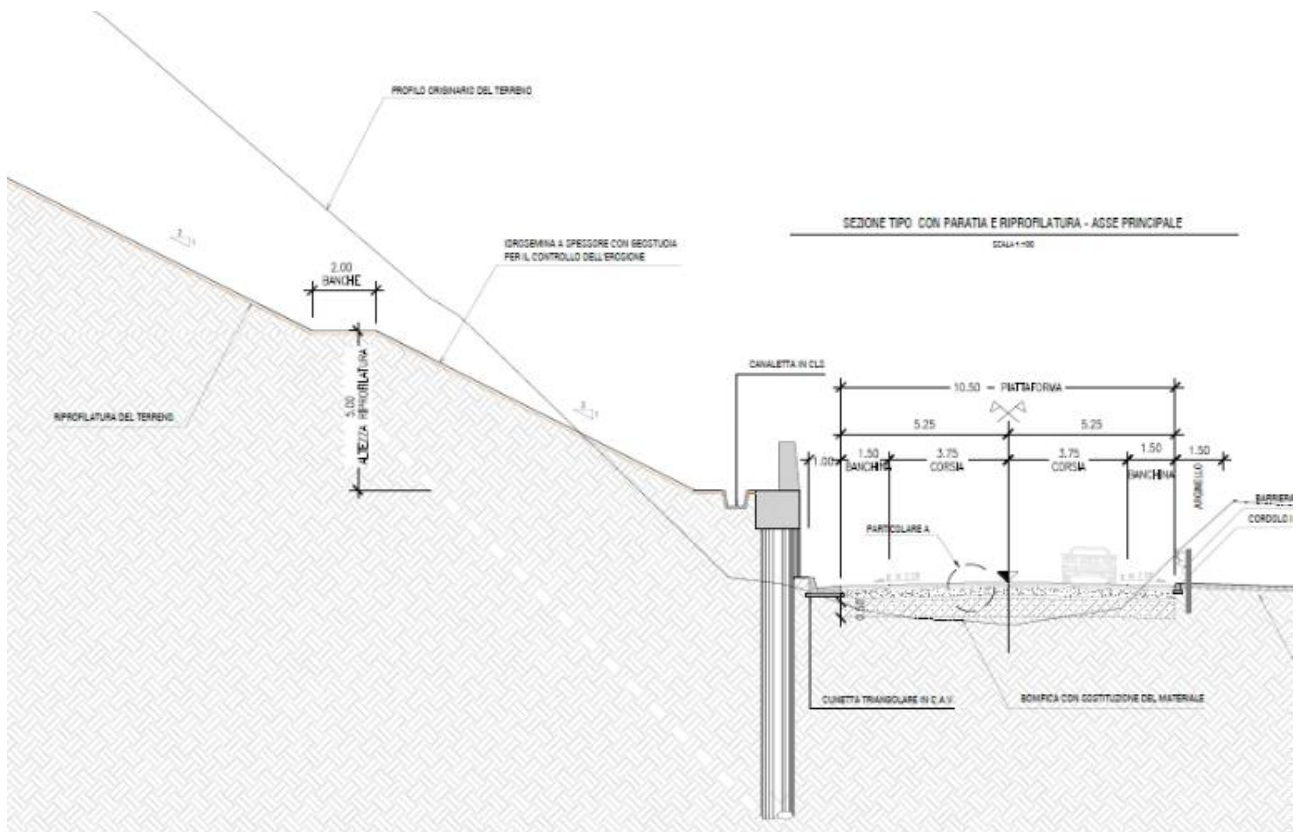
Riprofilatura scarpata – stralcio sezione tipo.
